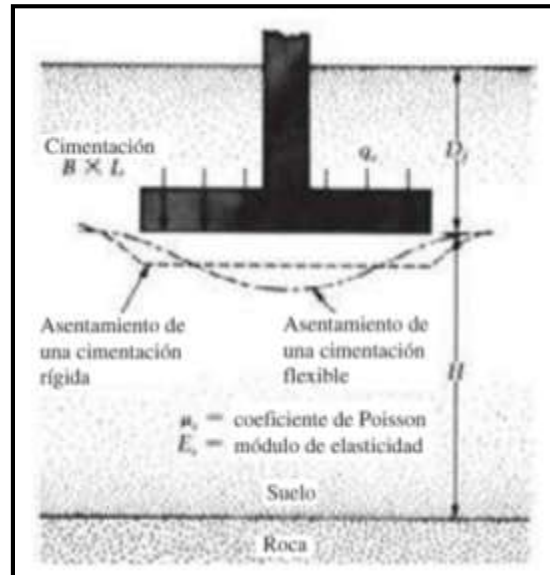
Asentamiento elástico de cimentaciones flexibles y rígidas (fuente: BRAJA M. DAS)
